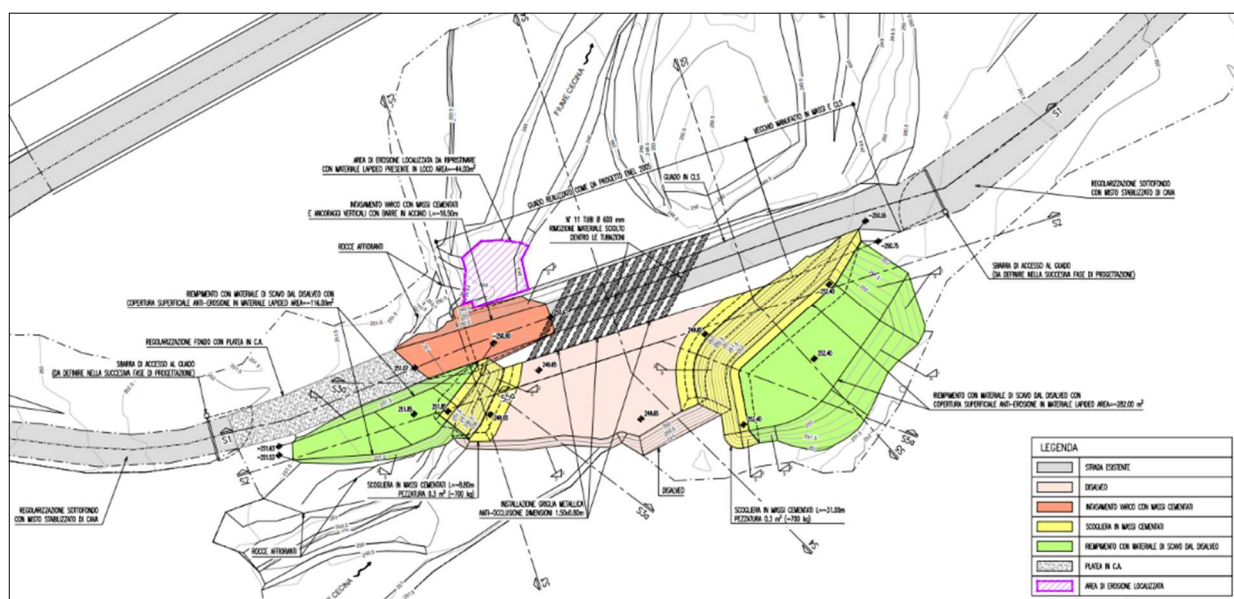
Stralcio planimetria generale delle opere in progetto, tavola GRE.EEC.D.28.IT.G.13407.00.081.00 R36081\_GuPPr.
